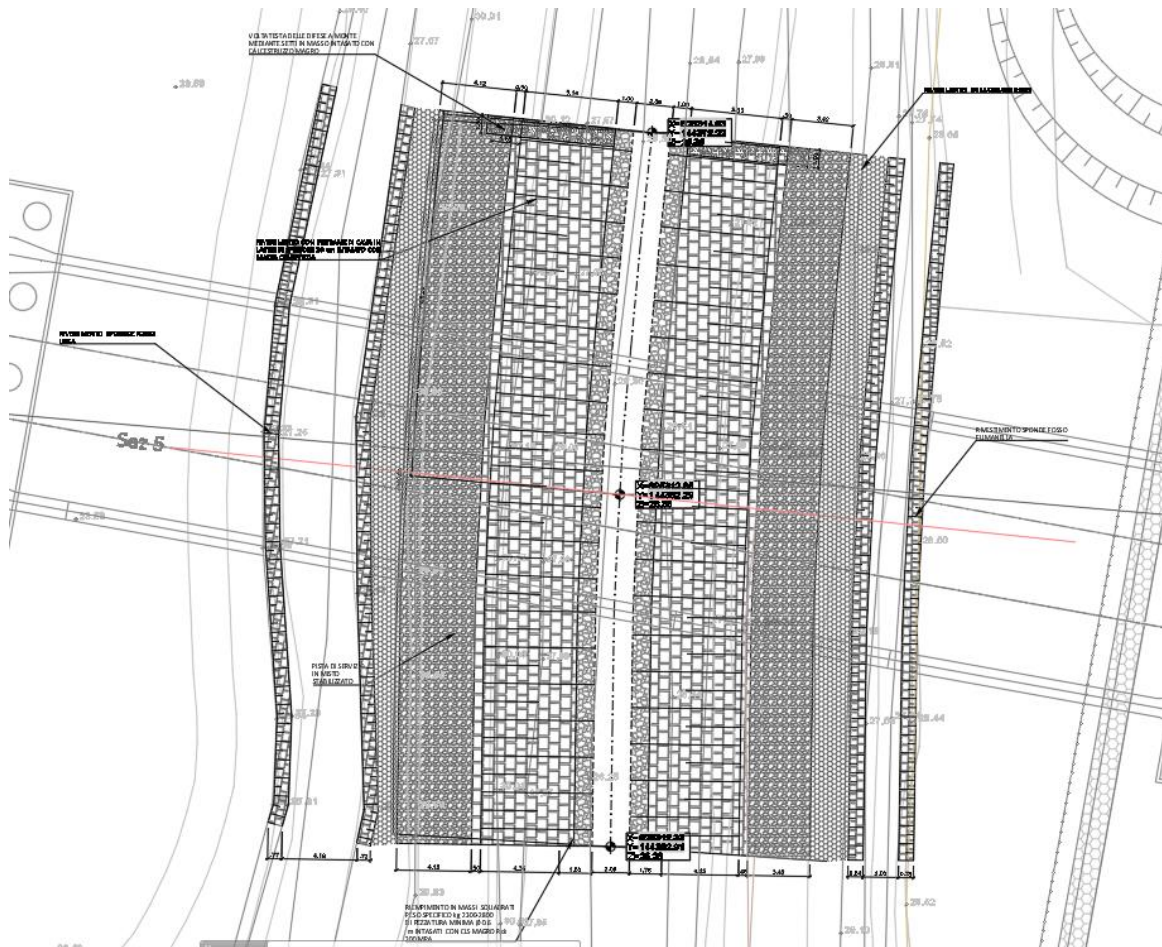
Torrente Fibbio - Stralcio planimetrico post operam.
